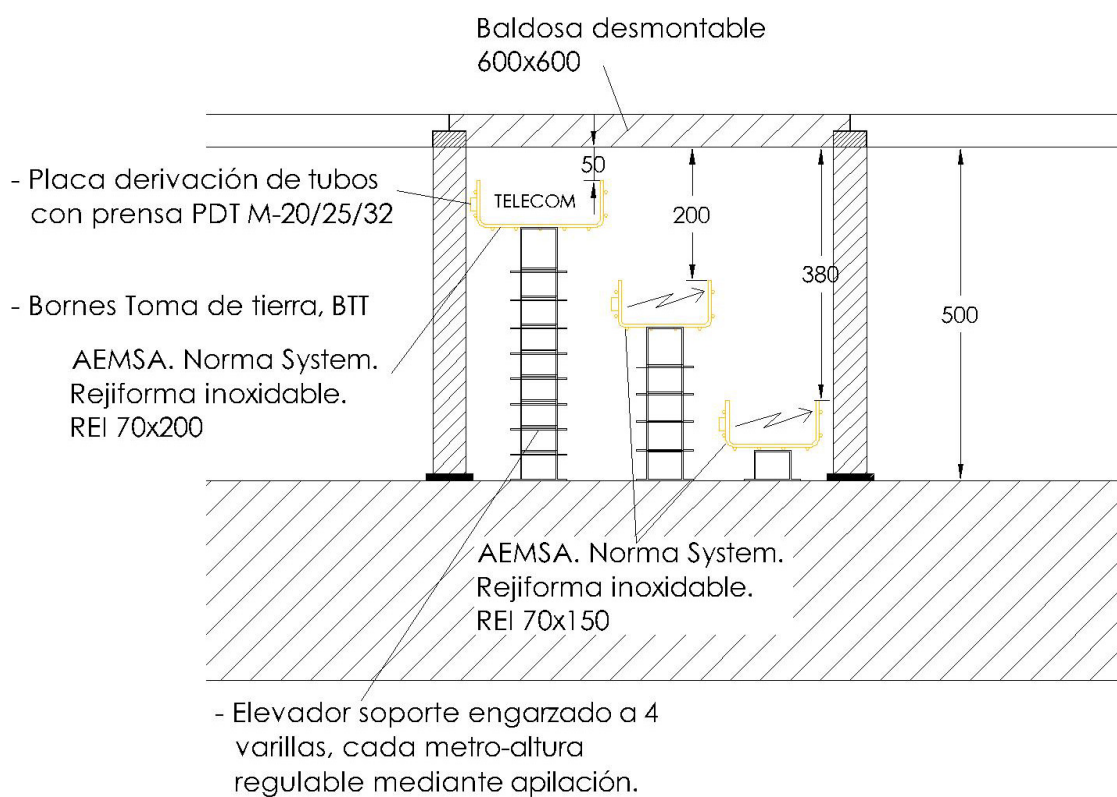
Esquema de montaje de las bandejas para cableado bajo el suelo técnico.
